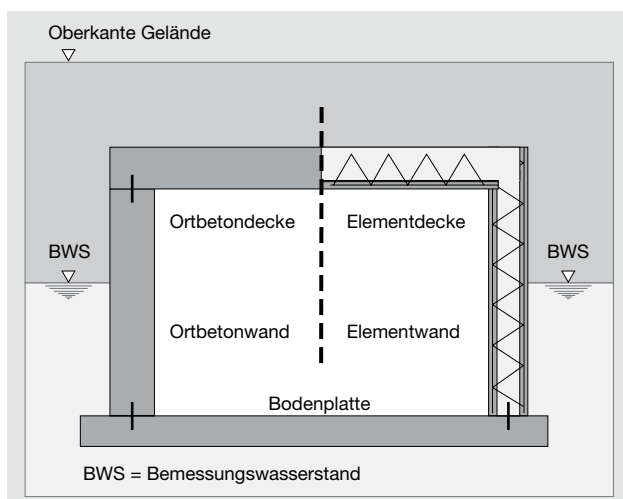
Wasserundurchlässige Bauwerke (Weiße Wannen) aus Beton ohne zusätzliche Abdichtung in verschiedenen Bauweisen
